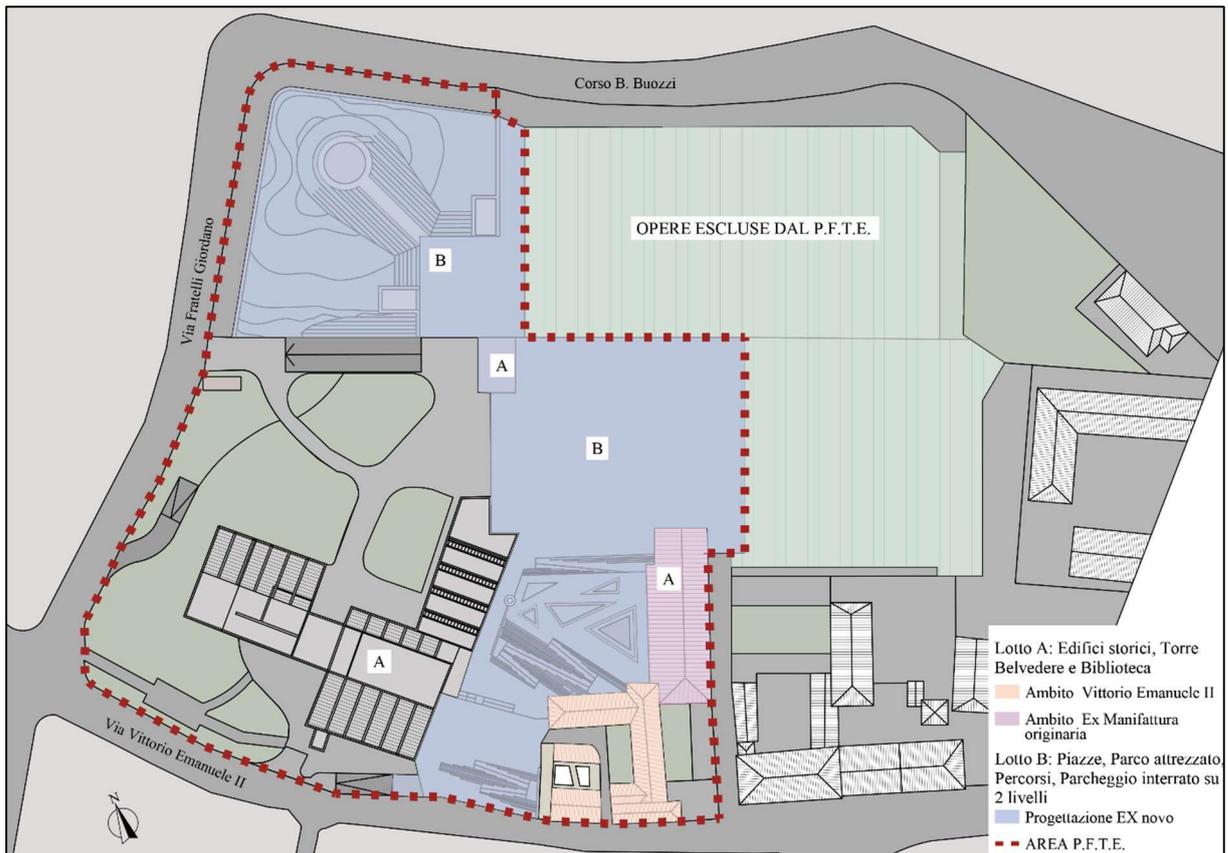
Individuazione dei lotti e dell'area di intervento (FONTE: www.comune.chieri.to.it)
